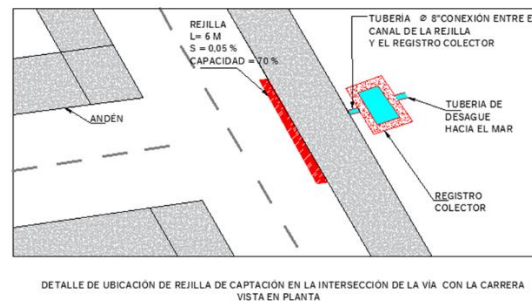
Vista en planta para Rejilla de captación. Fuente: Origen propio
